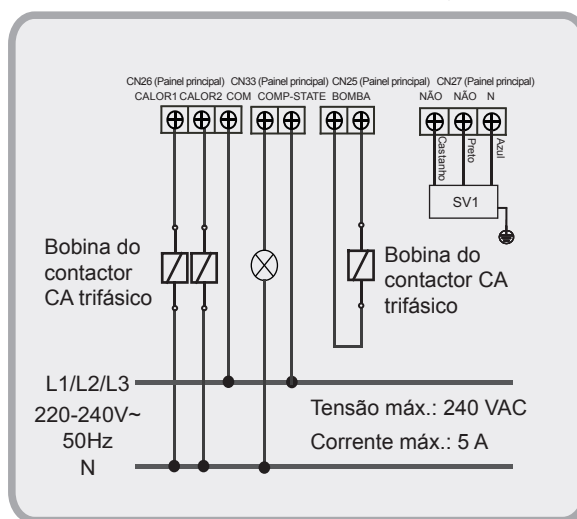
Cablagem da bomba de água e aquecedor auxiliar da tubagem e luz CA do estado do compressor (apenas para KEM-90 DRS5 KH e KEM-180 DRS5 KH)
